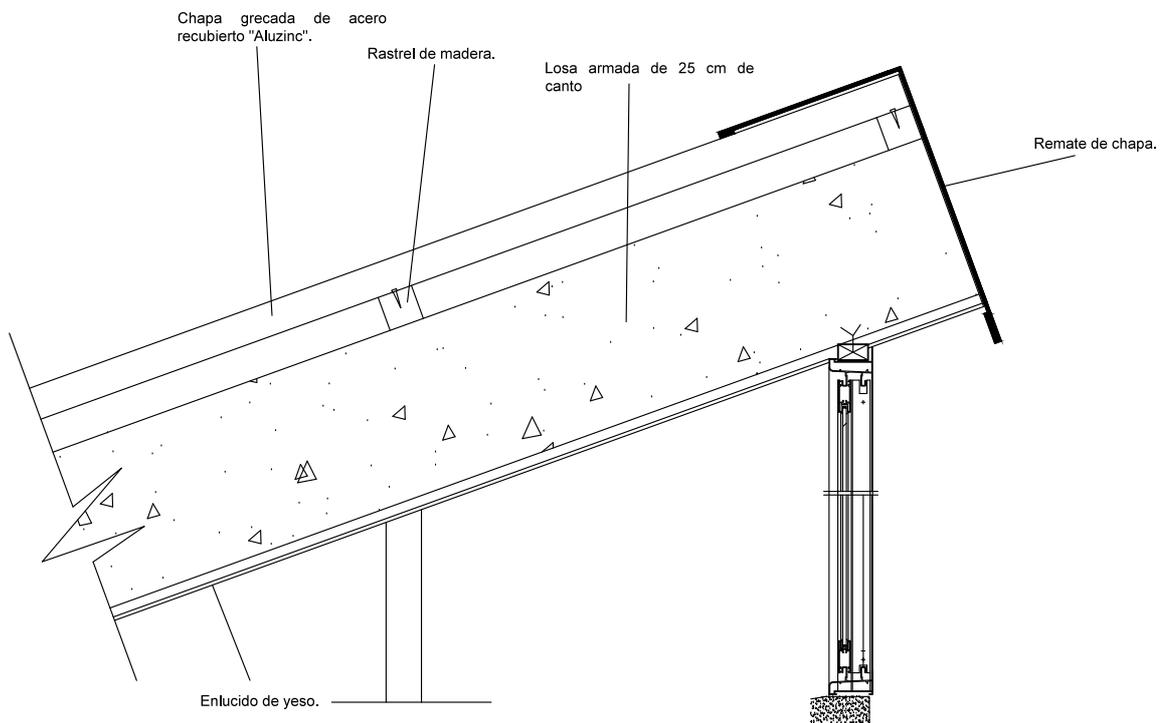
Detalle constructivo cubierta inclinada de chapa (Lucernario).
